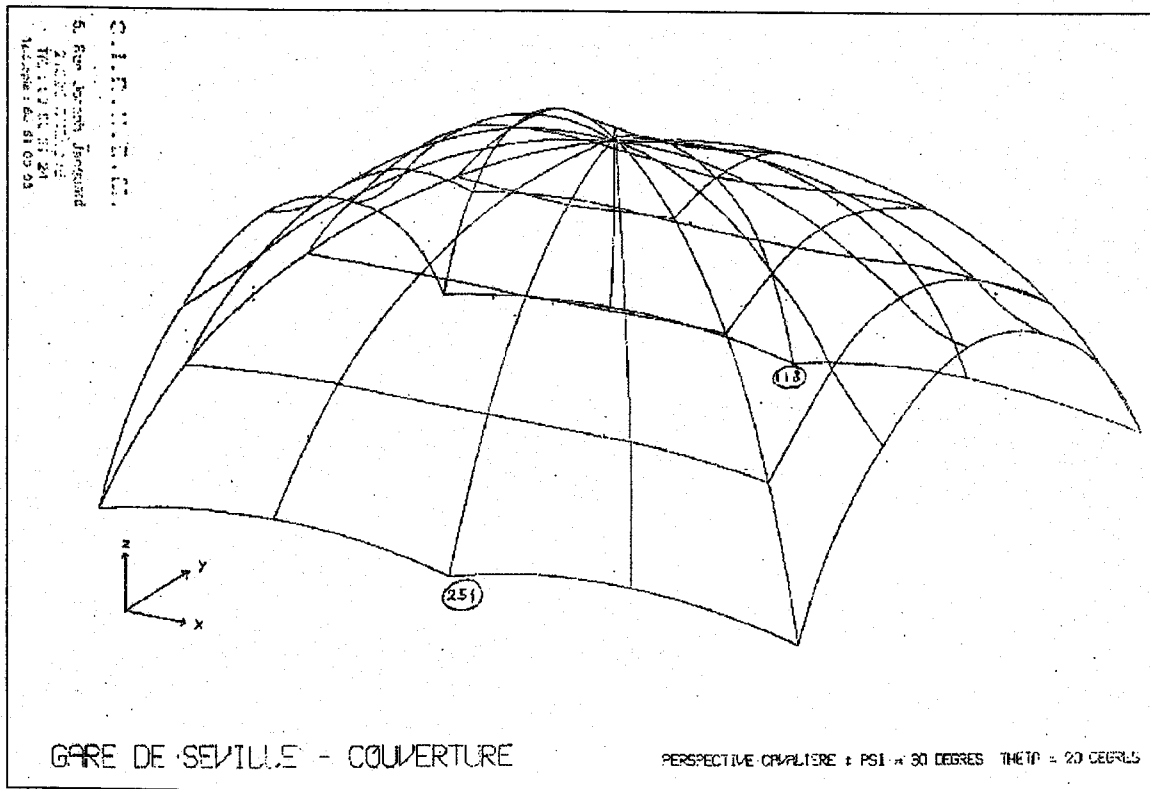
Croquis de un módulo de la cubierta del Apeadero del AVE .
